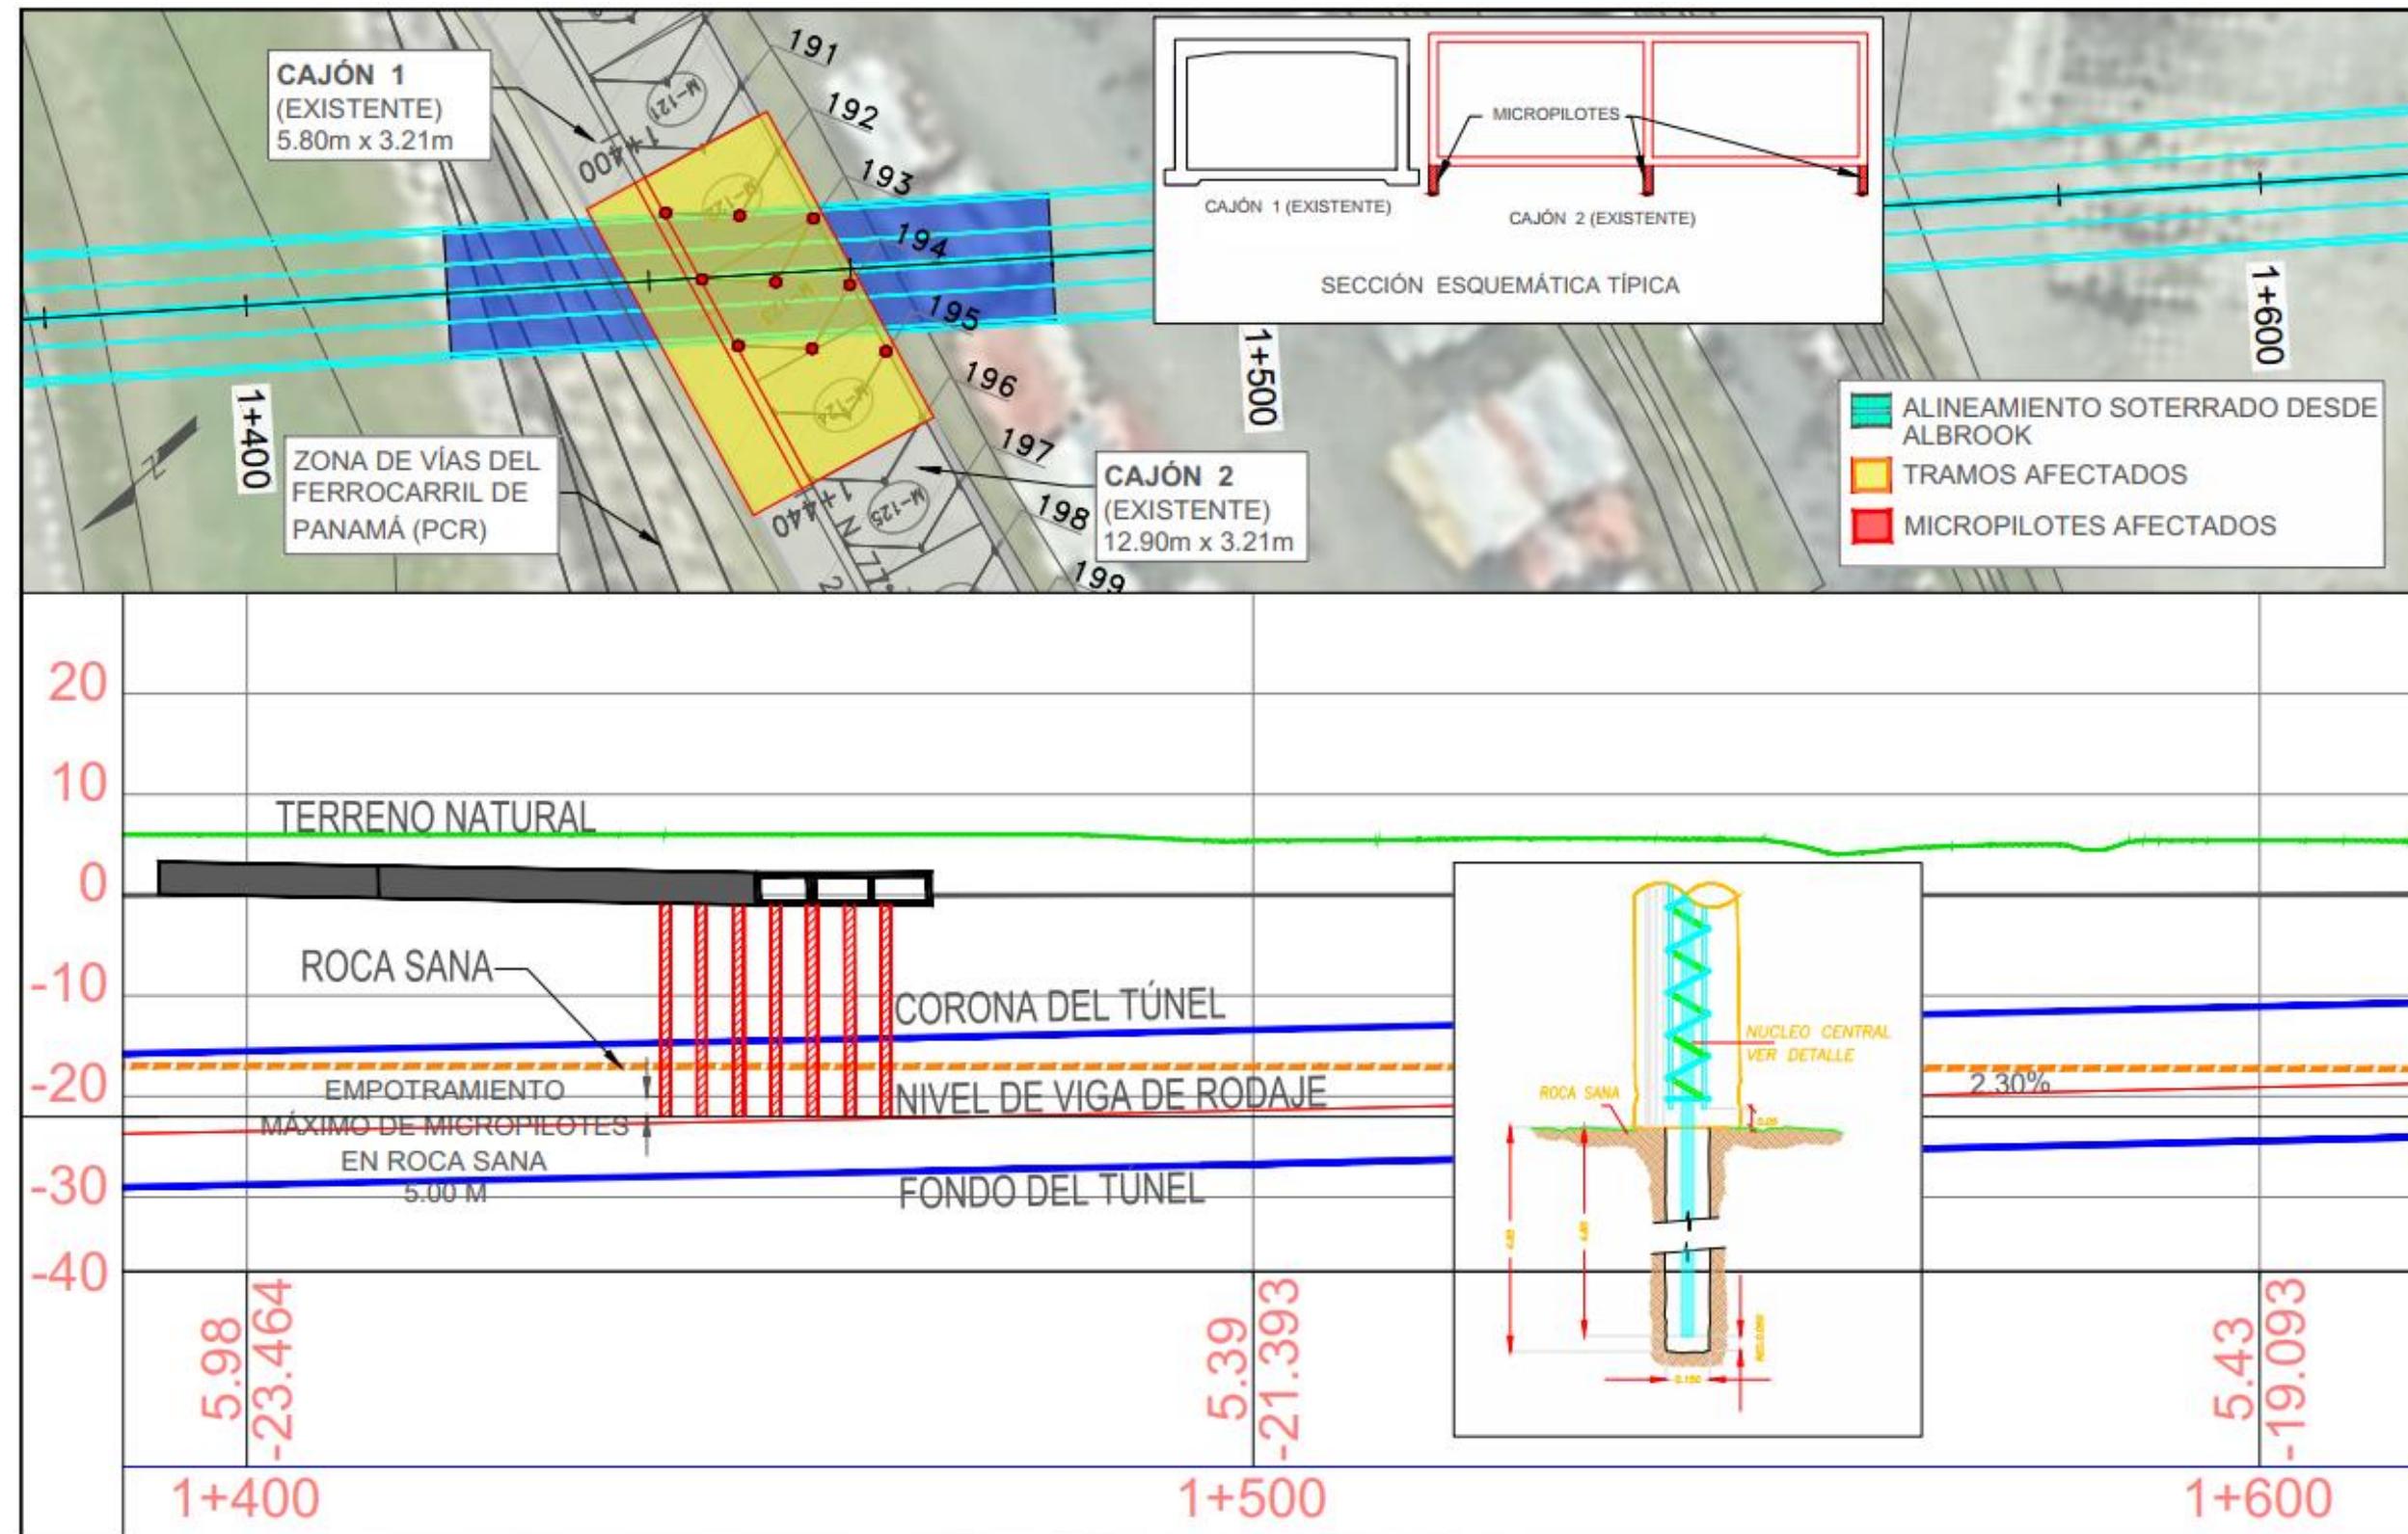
Planta-Perfil y Detalles de los cajones del Sistema de Drenaje Curundú afectados por el trazado del tramo subterráneo del Proyecto Metro Línea 3.
